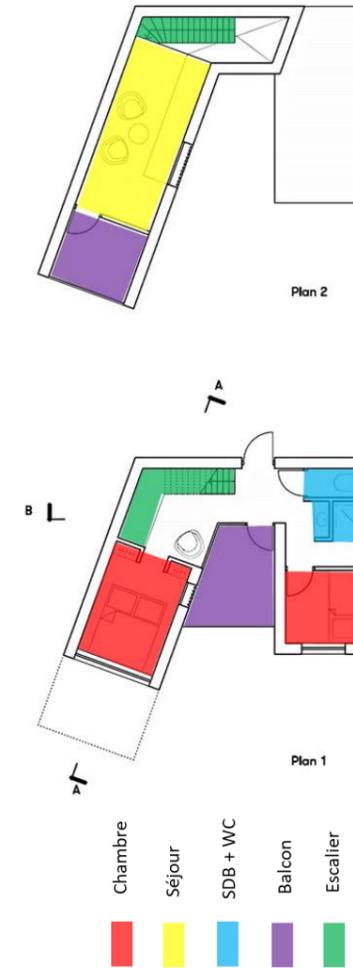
plan du chalet Fjell, source : Archdaily.com traité par auteur
